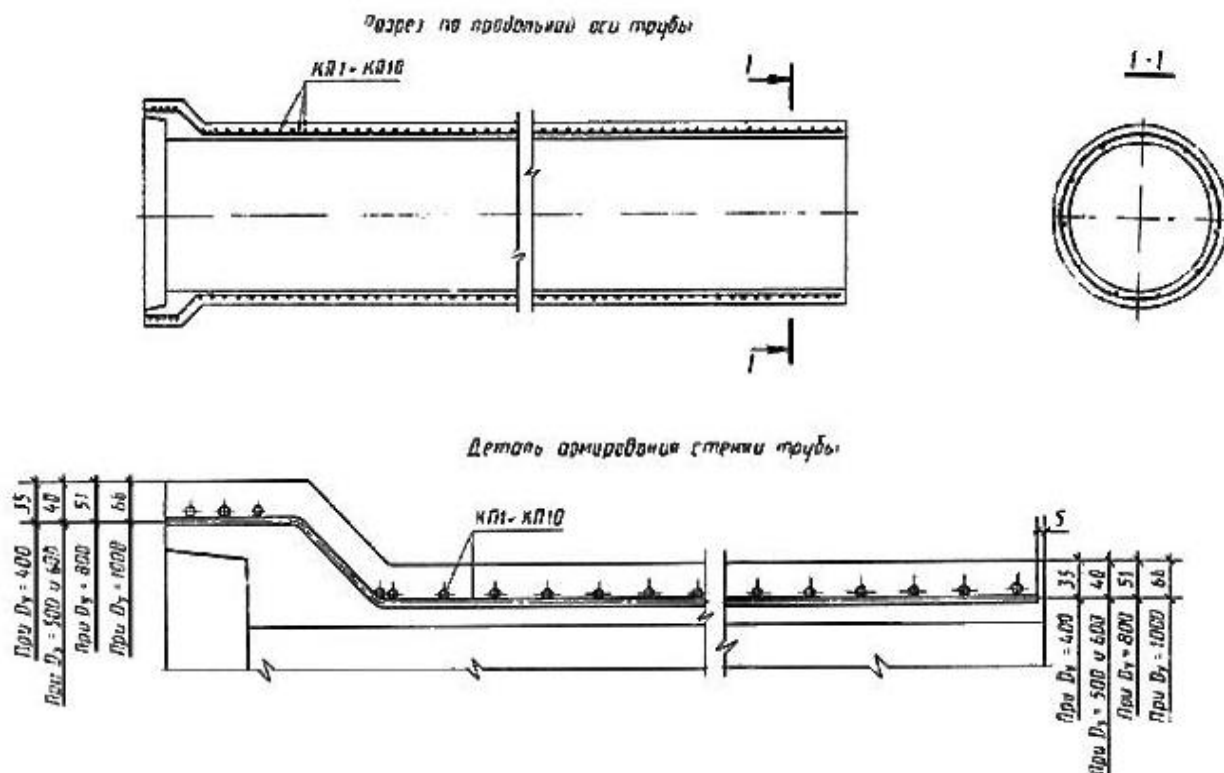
Армирование безнапорной железобетонной трубы Т80.50-2
